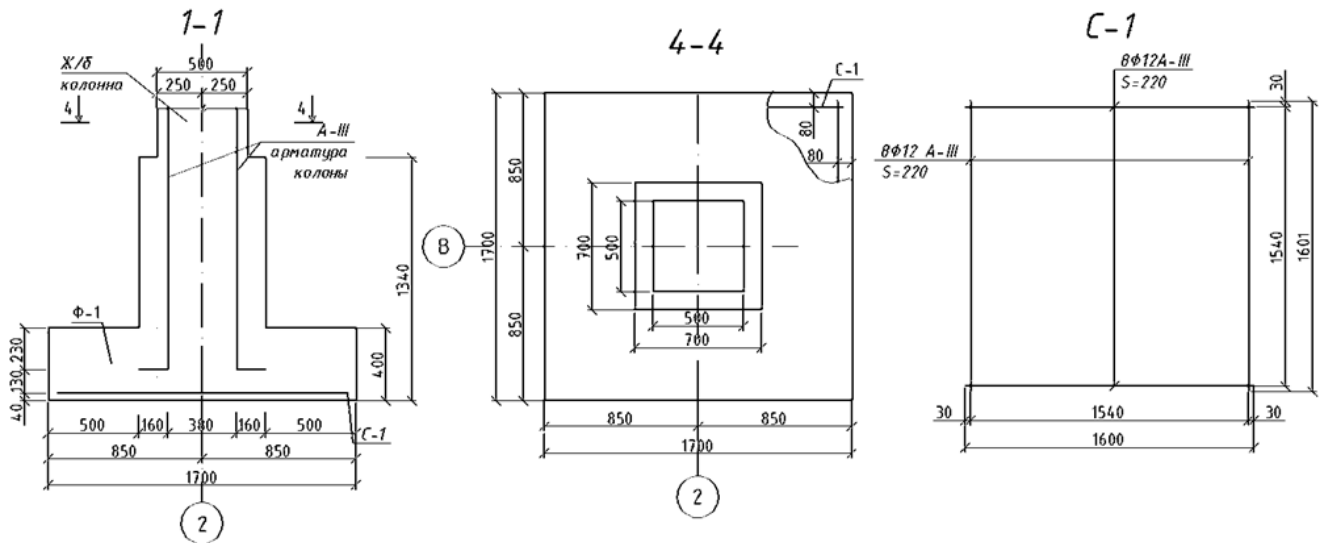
Конструкция фундамента колонны сечением 500х500
